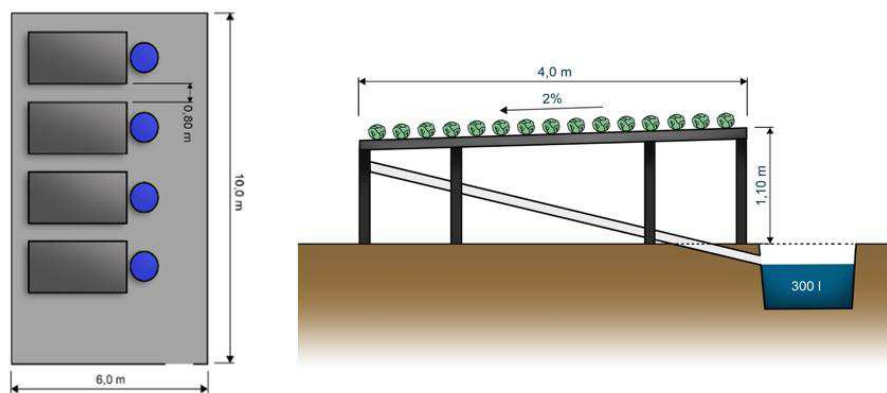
3. Planta baixa da disposição das bancadas e vista lateral da bancada em sistema NFT.
